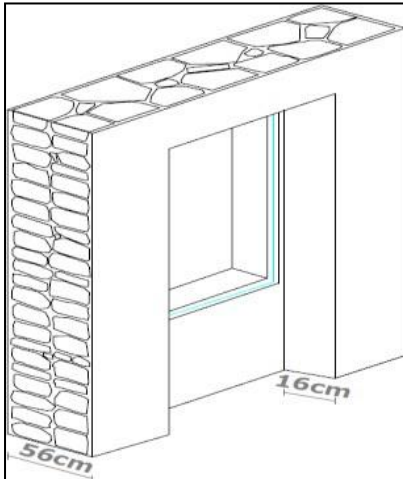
Montage des moellons lit par lit laissant un vide sur toute la hauteur du mur ((DALEL, 2006)
